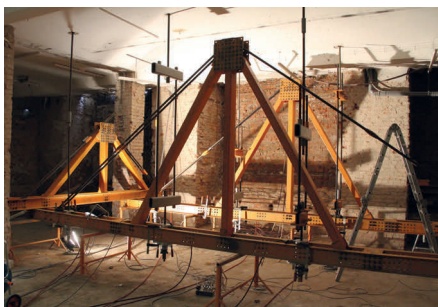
Widerlagerkonstruktion zum Lastabtrag; links: Untersuchungsbereich I (hier war ein zusätzlicher Querrahmen zur Verankerung des Widerlagers im Bestand notwendig, ganz links im Foto zu sehen); rechts: Untersuchungsbereich II
